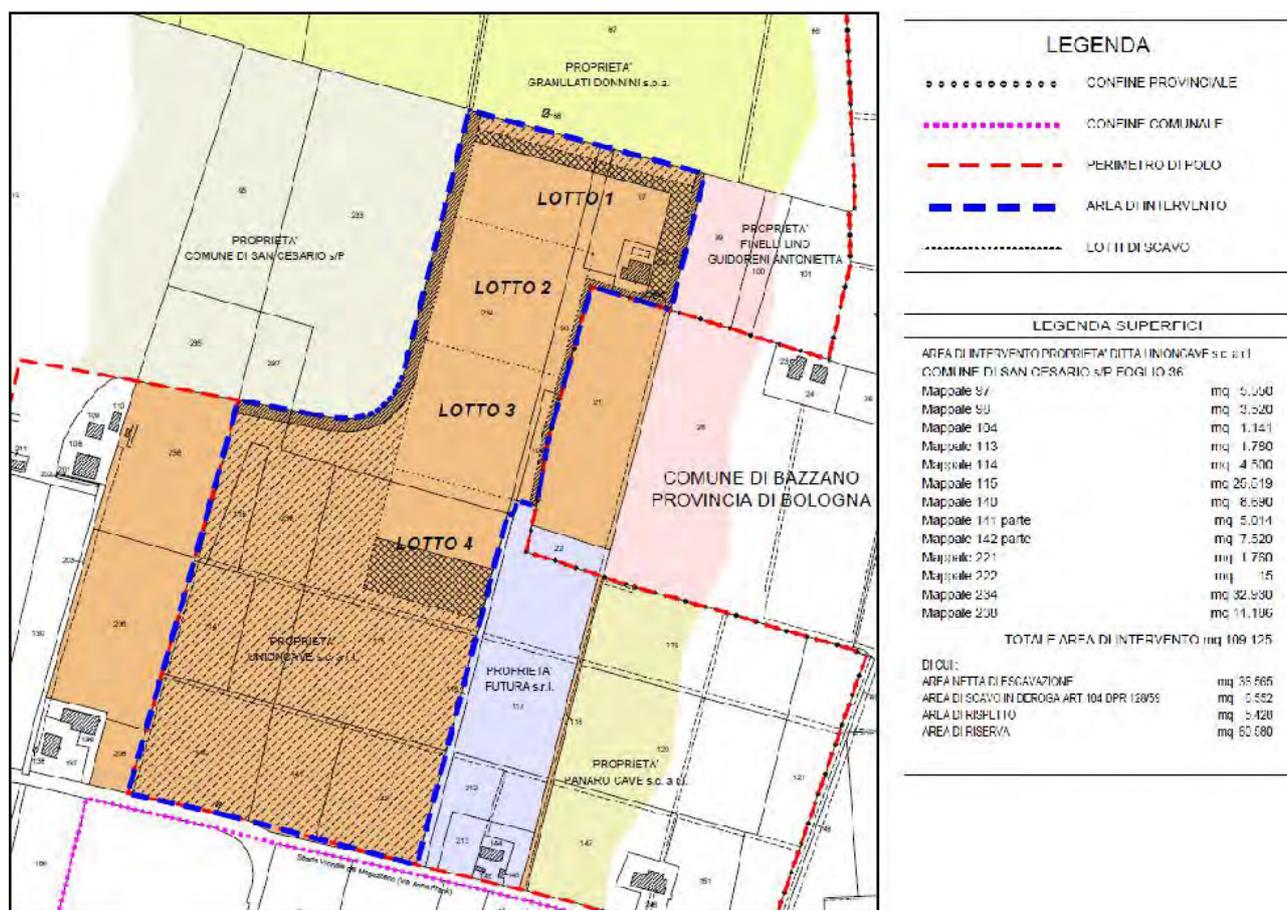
Estratto Tavola 02 Progetto di Coltivazione e Sistemazione
